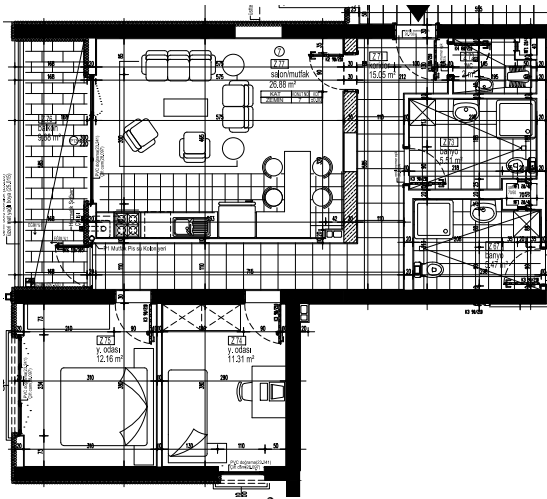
40. D Blok 150 m² büyüklüğünde daire tip planı
